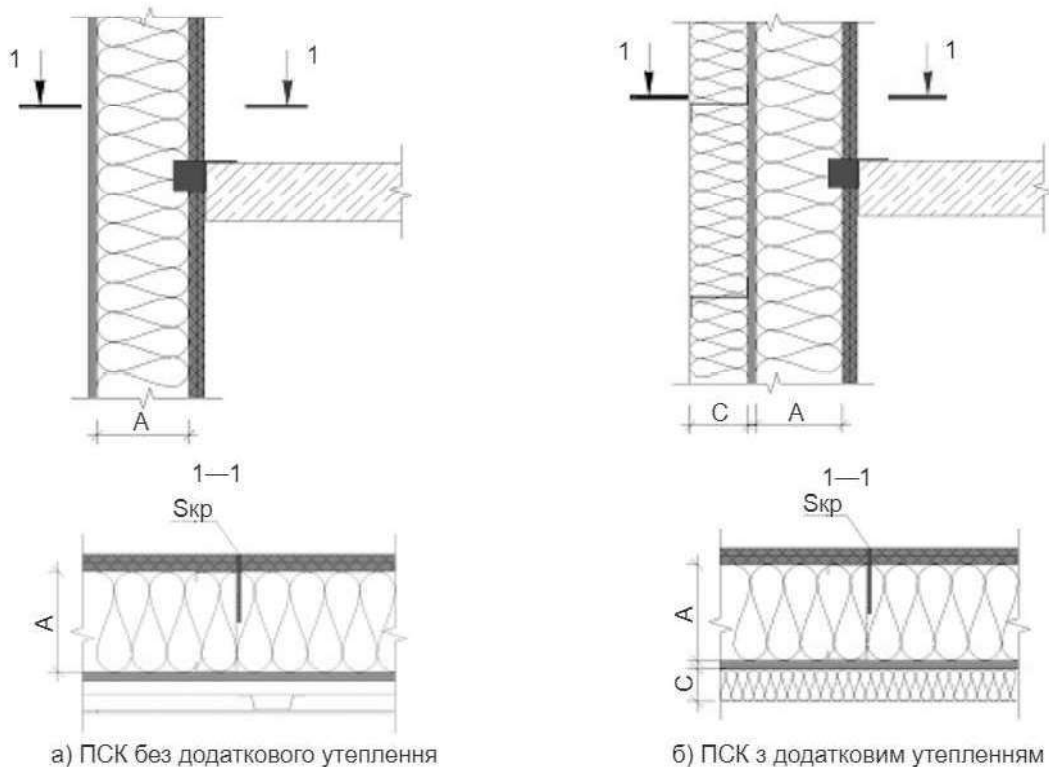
Схеми вузлів кріплення навісних ПСК на каркас
